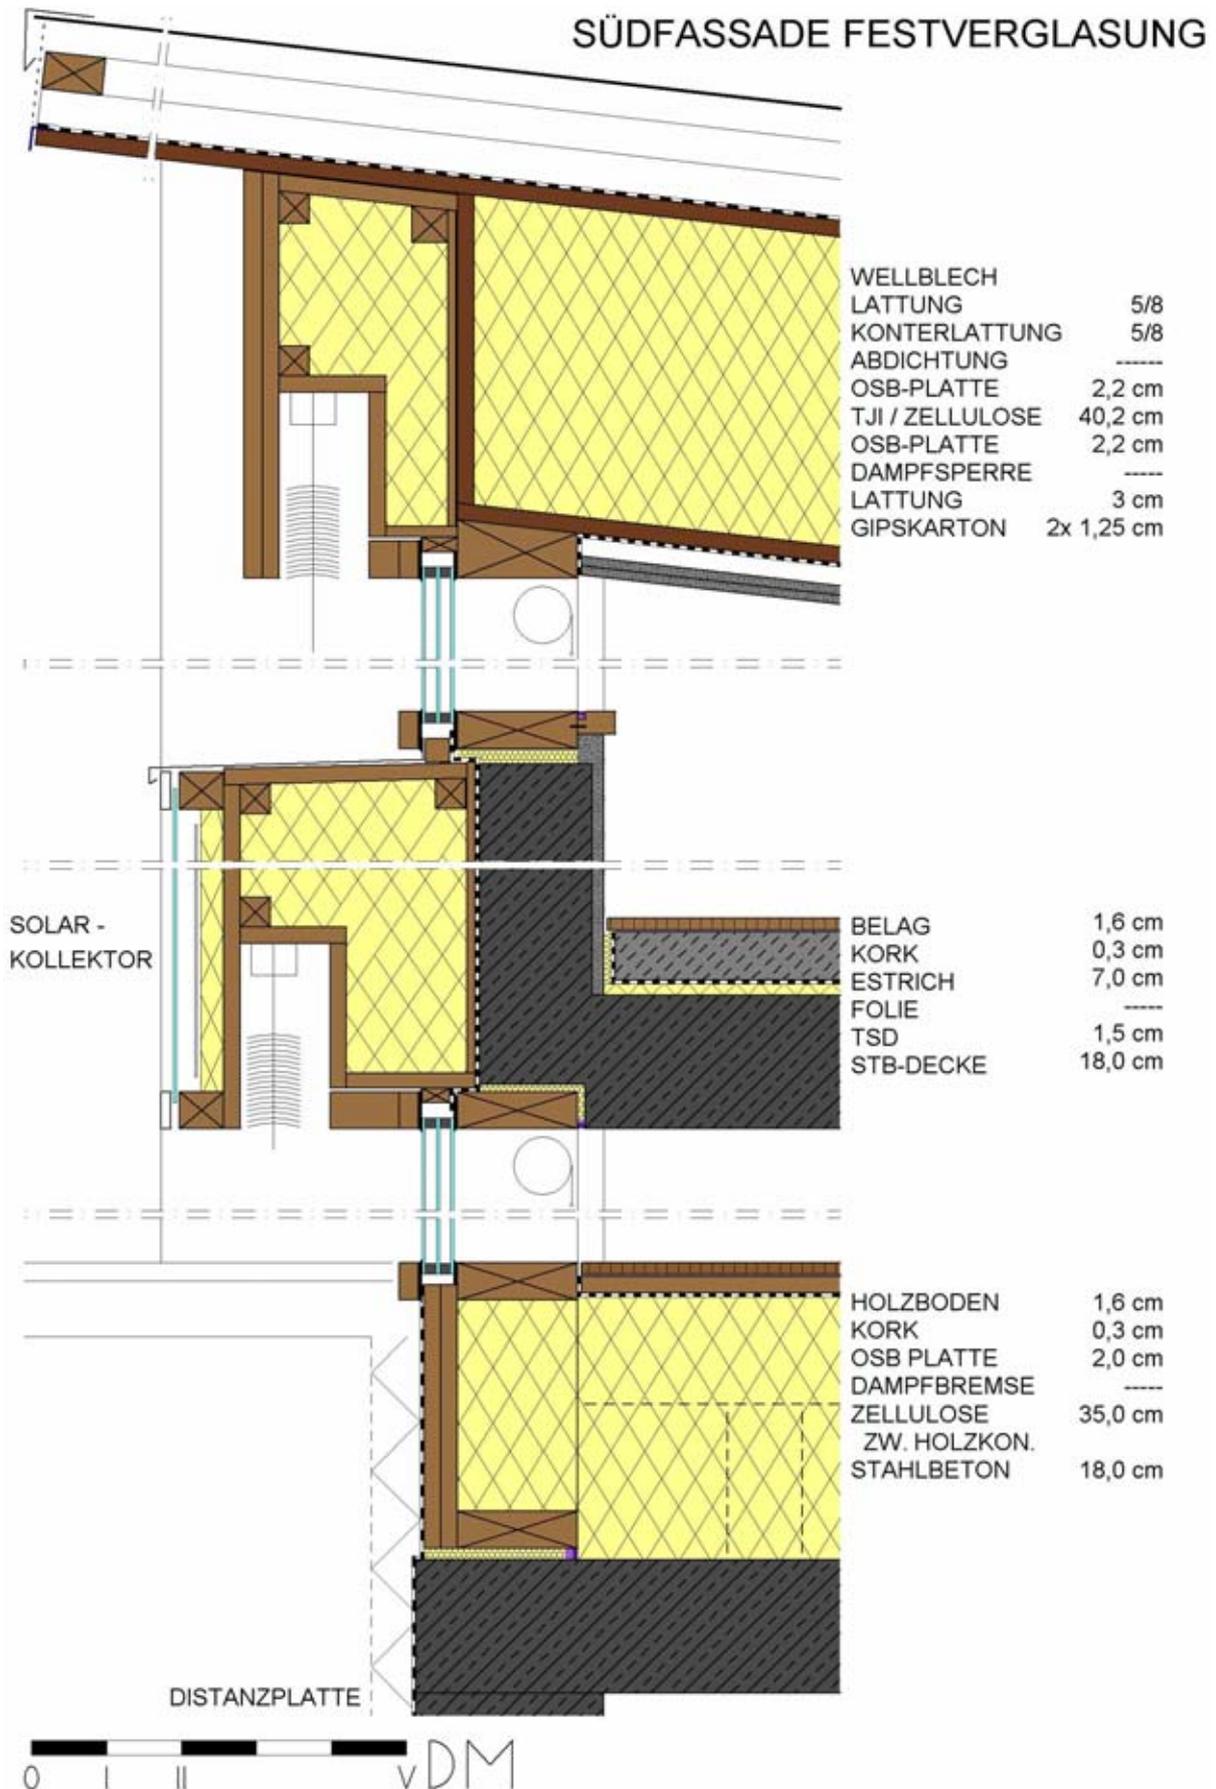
Vertikalschnitt durch die Südfassade (mit Fixverglasung)
